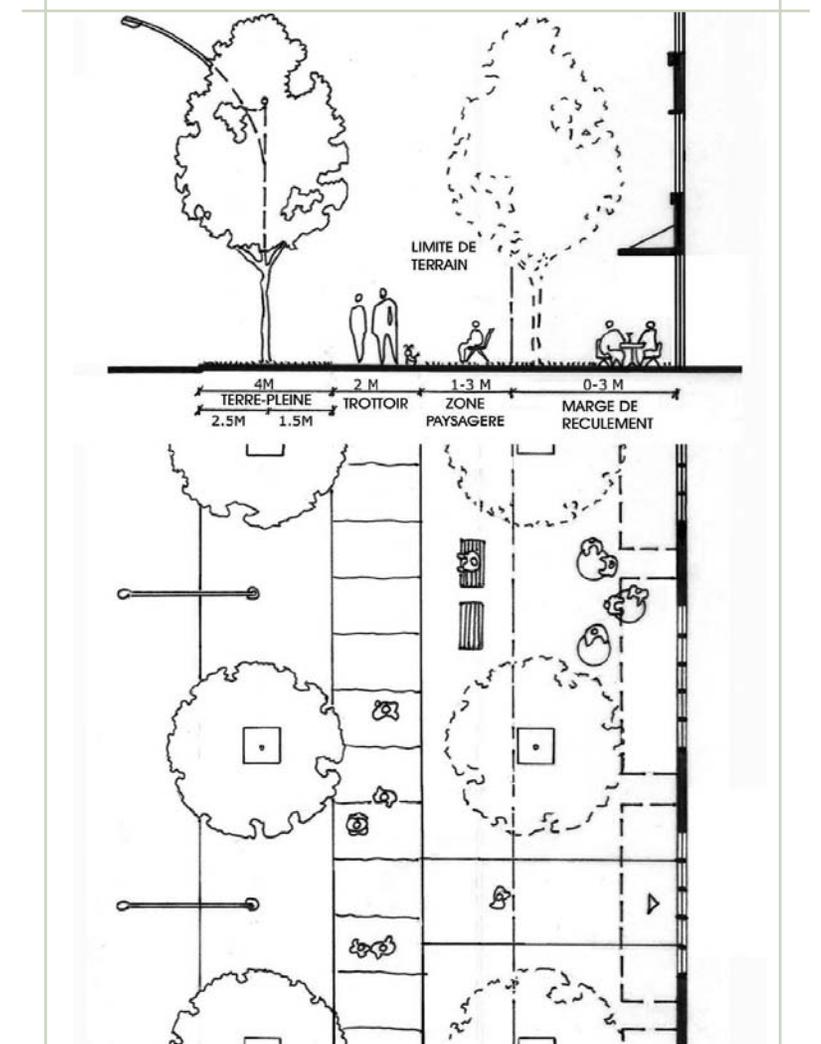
Paysage de rue d'une grande artère : coupe de l'emprise et plan.
